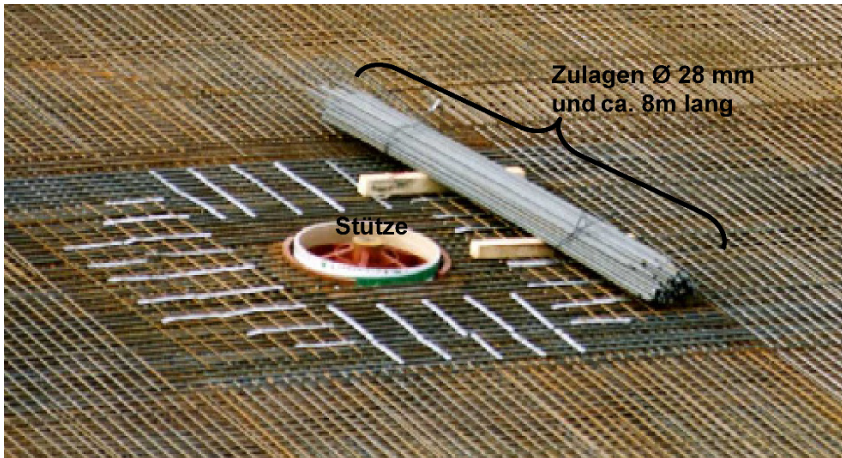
Dübelleisten mit schwachen Haltebändern plus stärkeren Zulagestäben an der Stütze einer großen Platte
